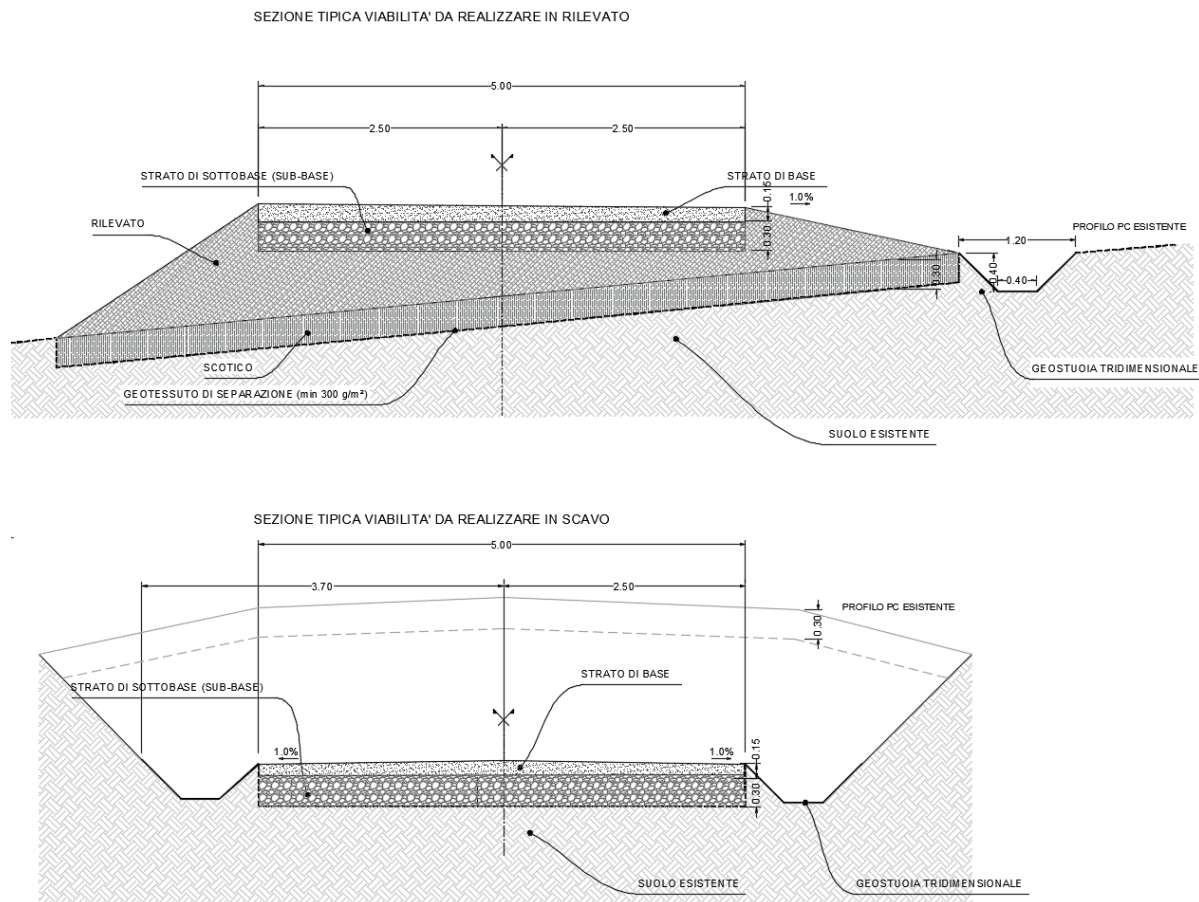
Sezione trasversale viabilità di nuova realizzazione (Fonte: elaborato C24FSTR001WD01800_Tipico sezione stradale)
